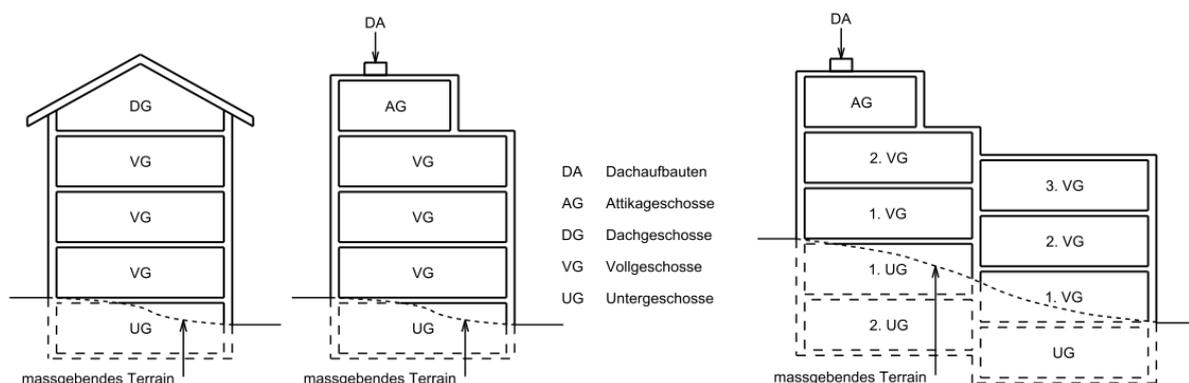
Figur 6.1 Geschosse und Geschossezahl, IVHB
